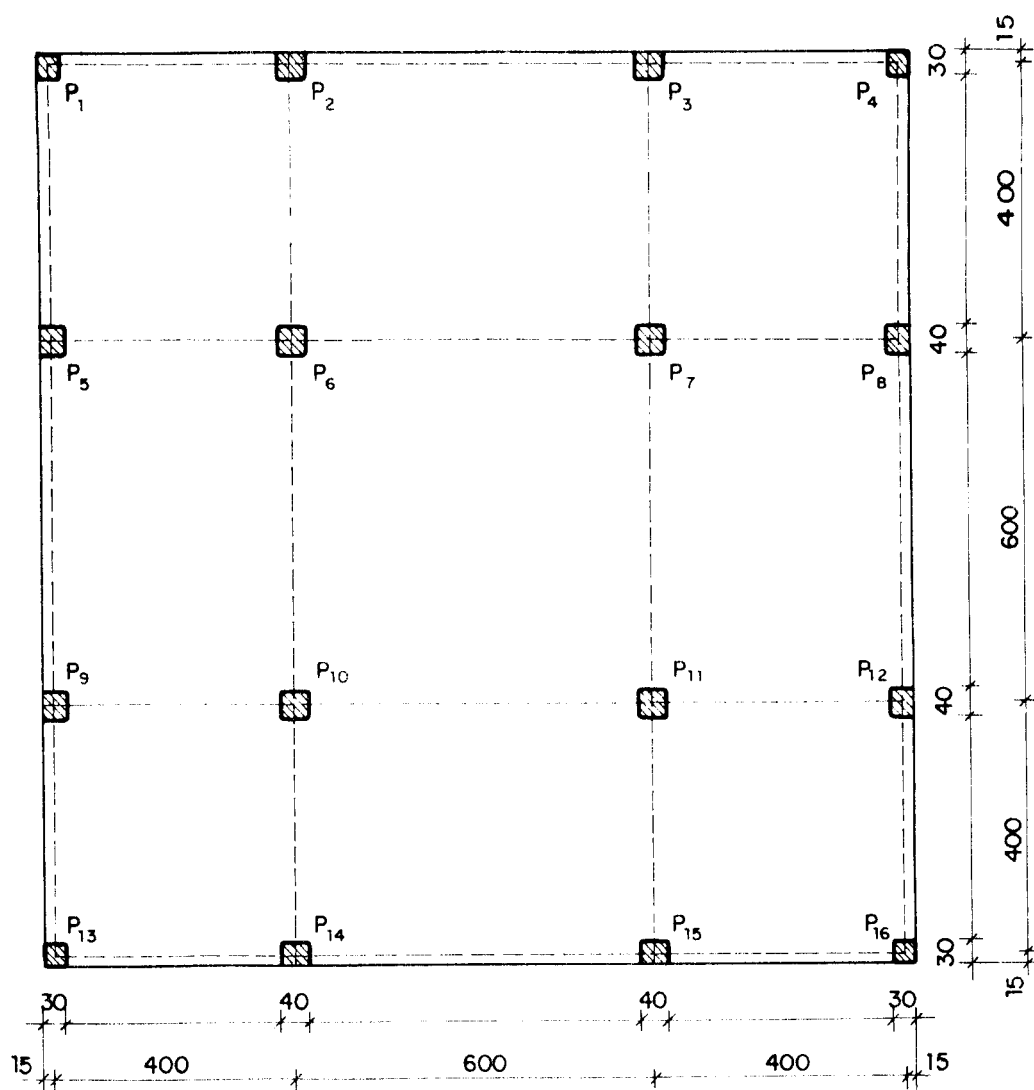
PAVIMENTO DO EXEMPLO RESOLVIDO .
